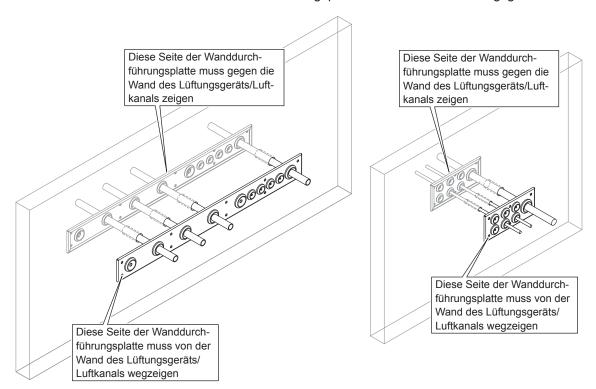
Wanddurchführungsplatte montieren Abb. 28: Wanddurchführungsplatte (Aussenmontage) montieren (Innenmontage)
